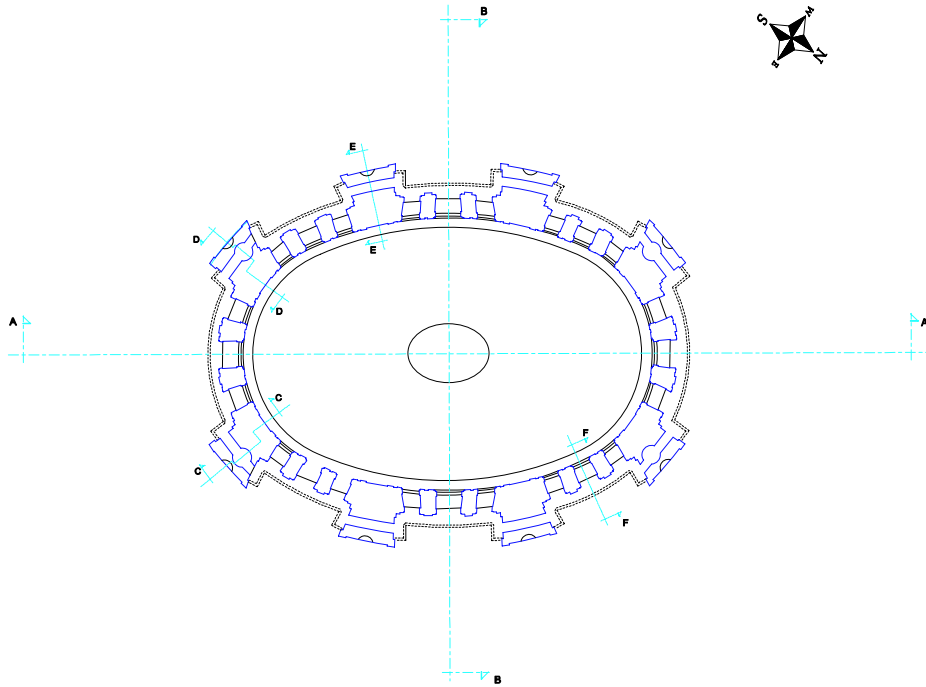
教会堂の平面図 (第 1 コーニスレベル)
